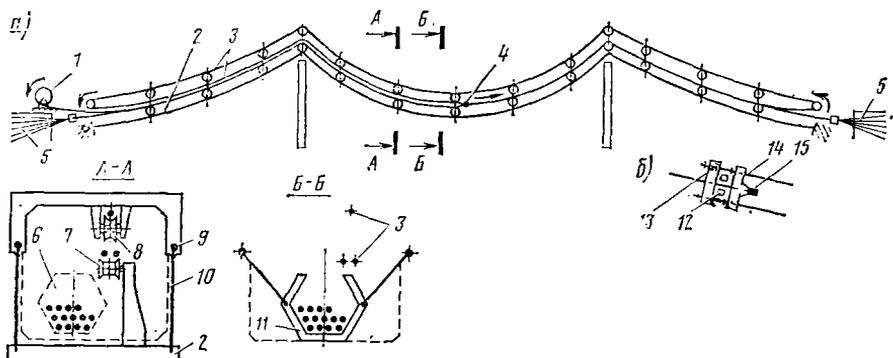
Схема сборки кабеля из канатов спиральной свивки и деталь устройства для натяжения каната:
